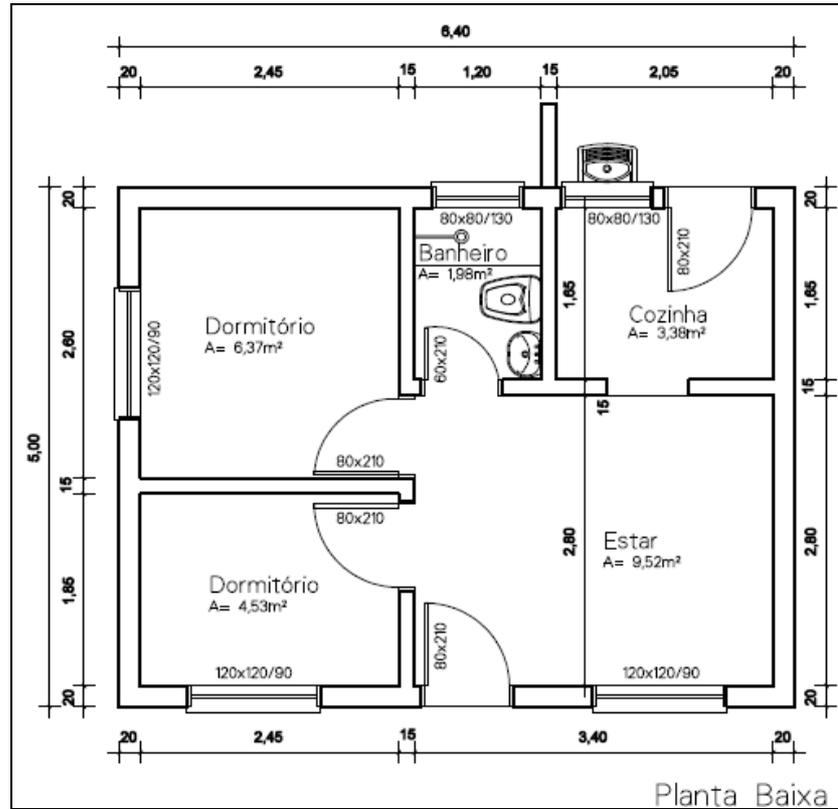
Planta baixa casa 2 dormitórios – Conjunto habitacional COHAB Duque – 32,00m²
